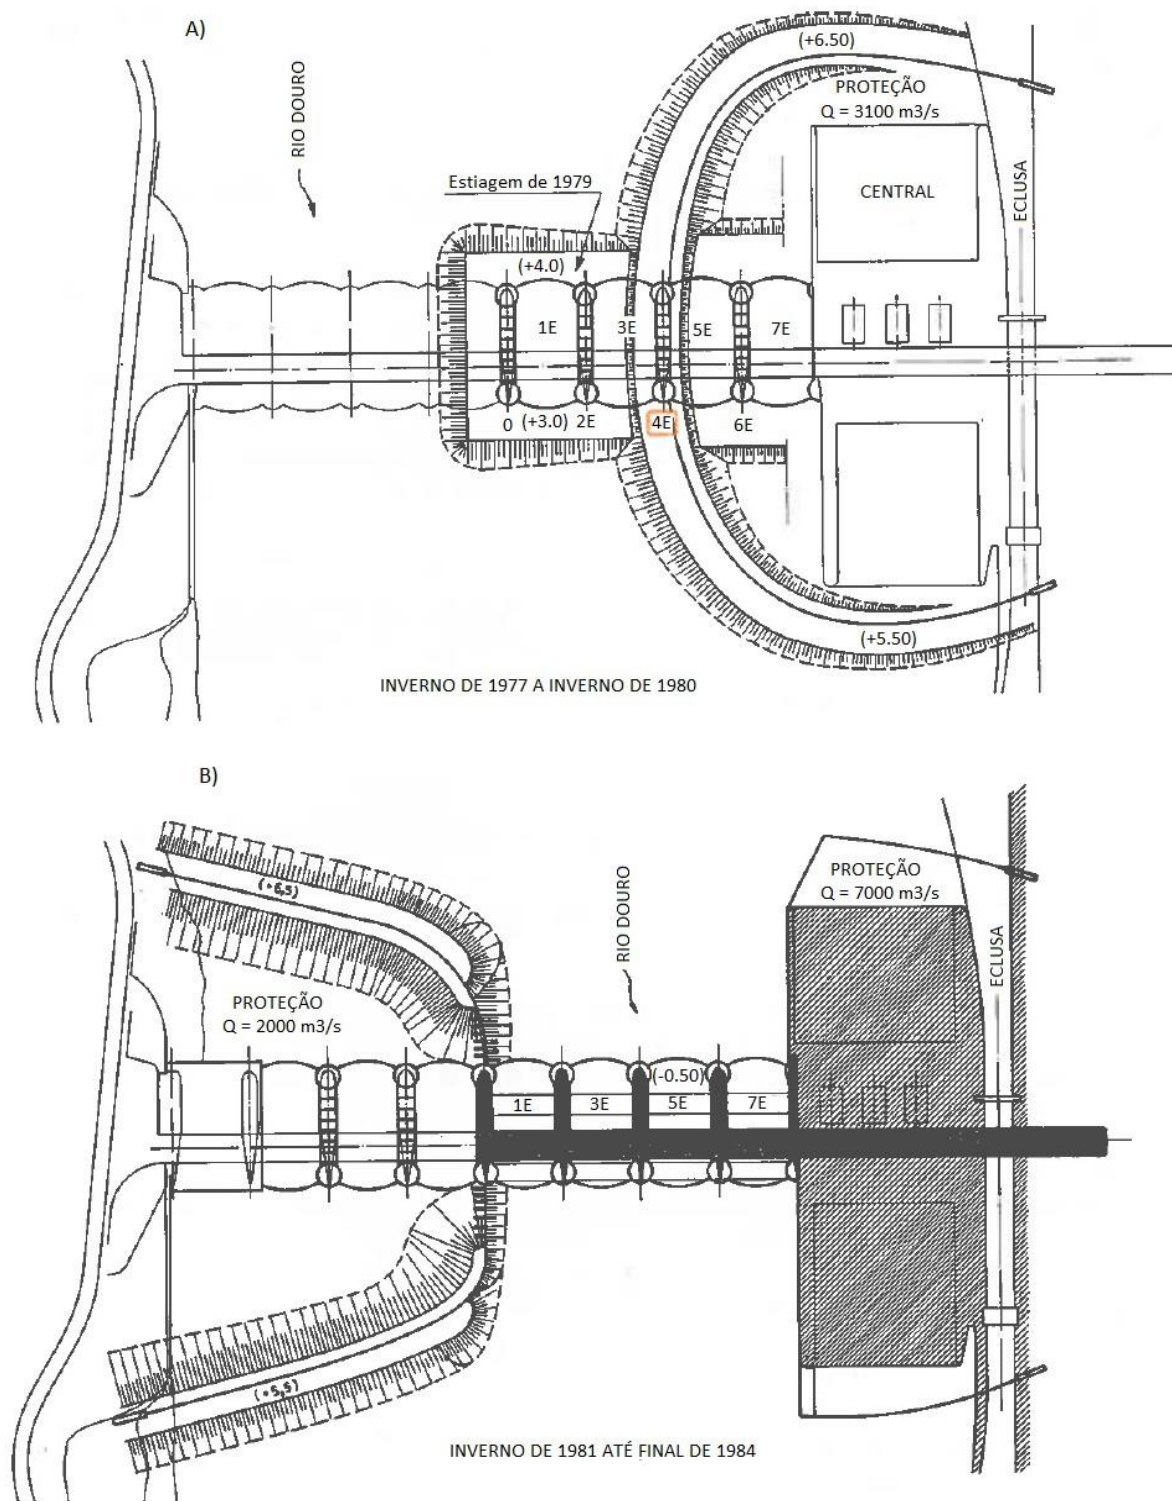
Planta das duas fases de construção da barragem, a) primeira fase; b) segunda fase [8]
